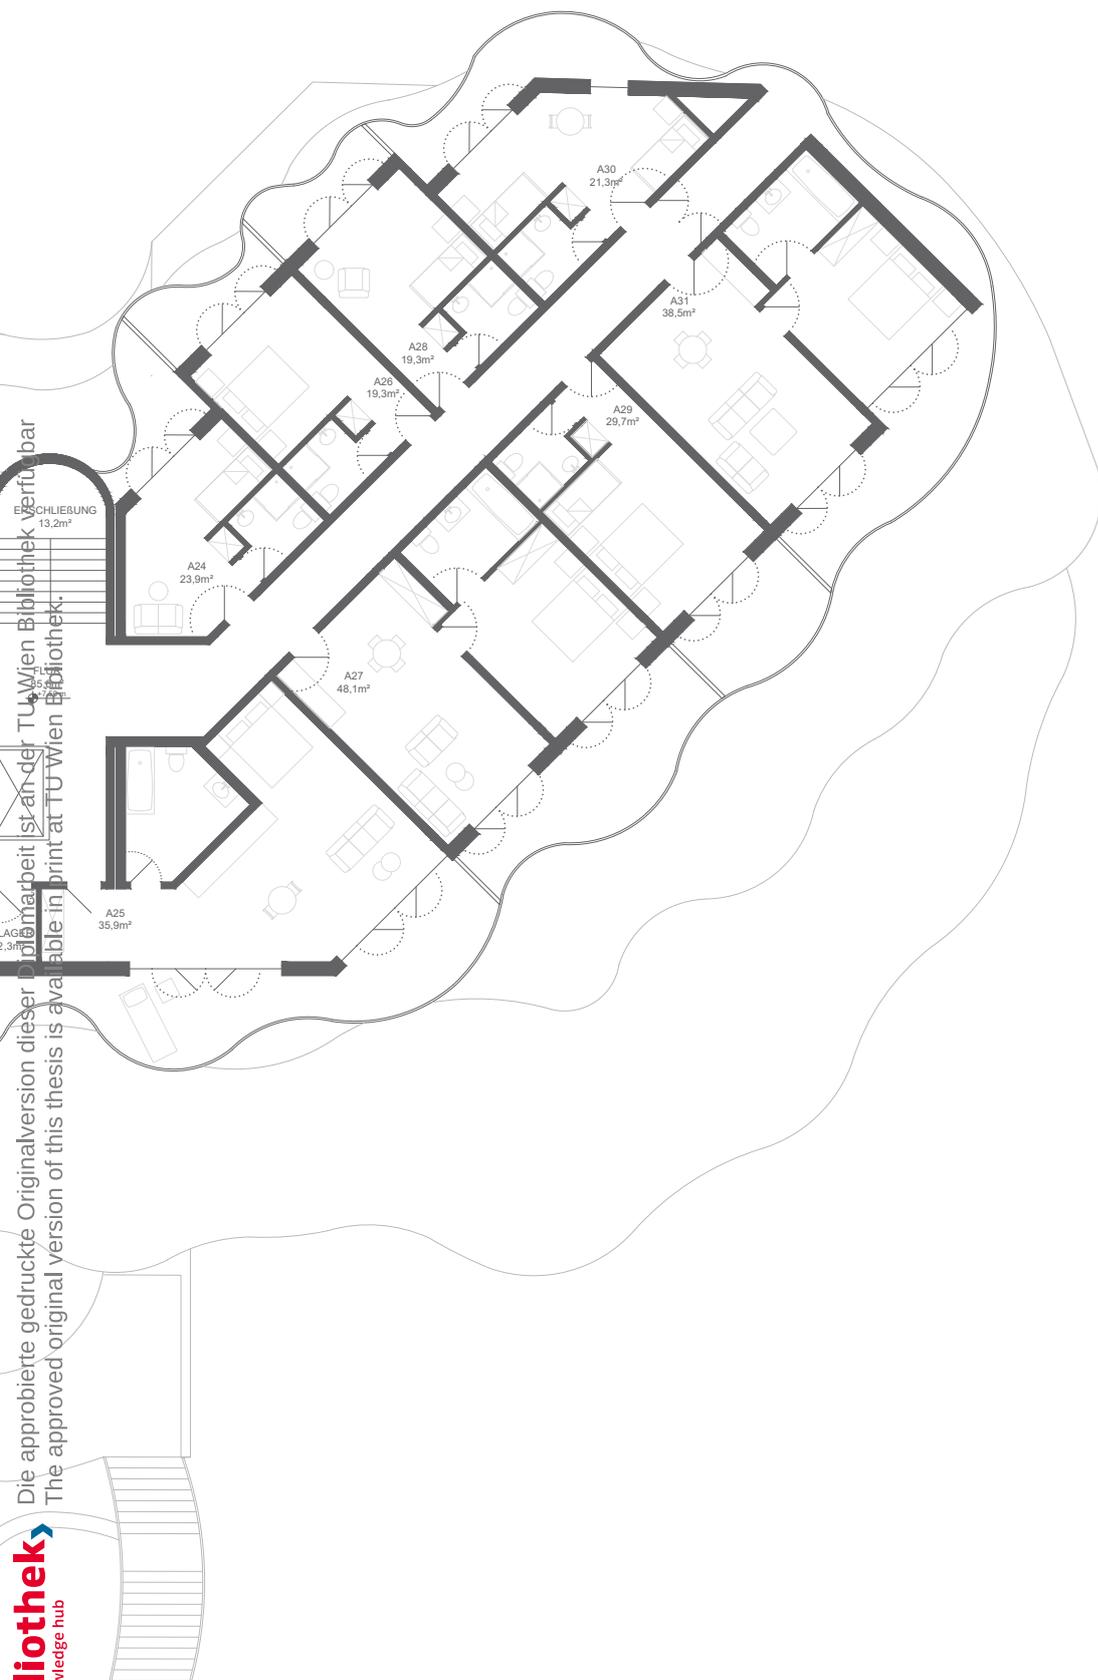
Grundriss 2. Obergeschoss
